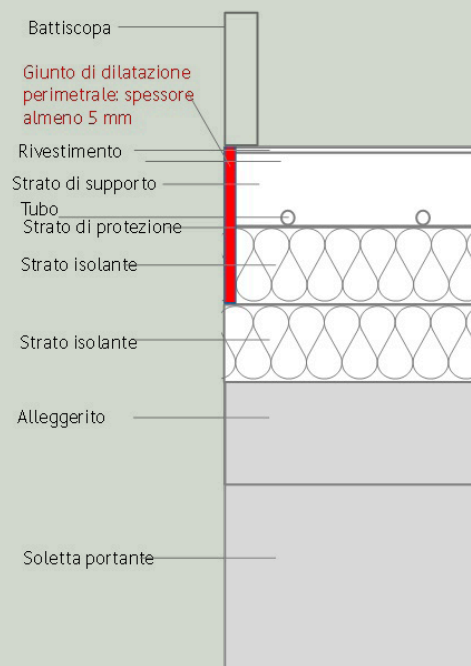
Sezione sistema radiante a pavimento con isolanti multipli (figura non in scala)
